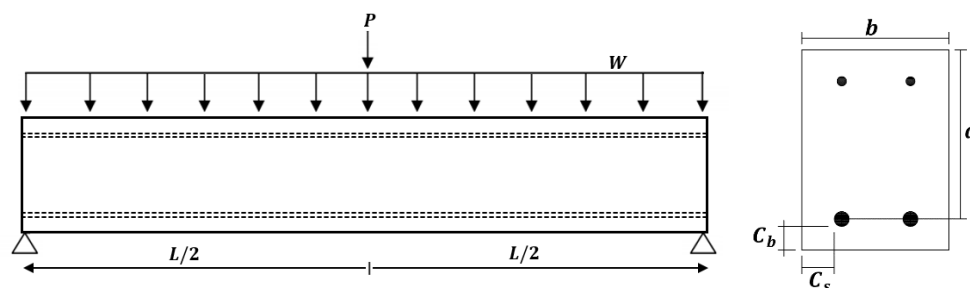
Configuração do carregamento longitudinal e detalhamento transversal das vigas.
